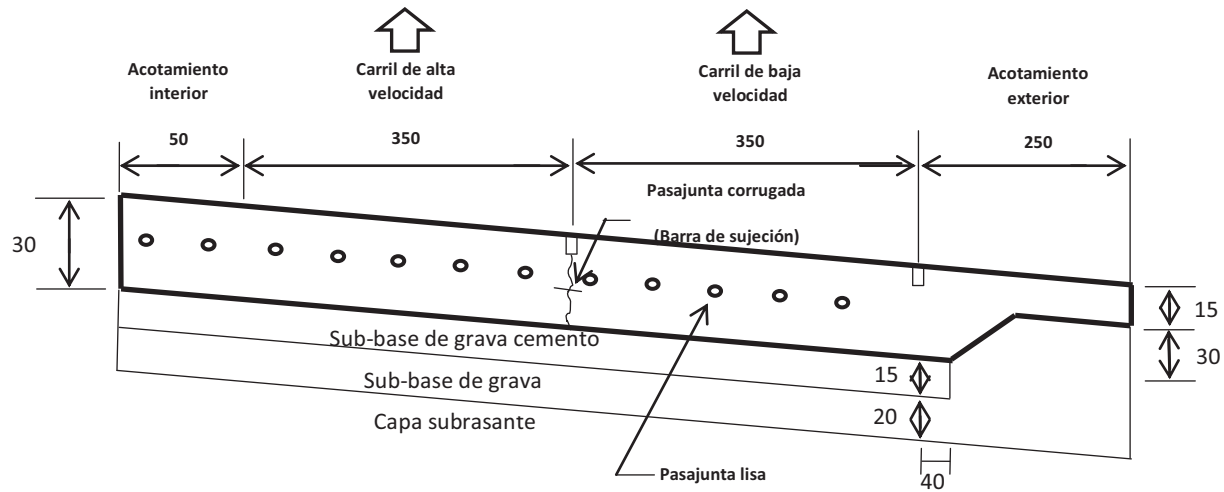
Sección transversal típica de un pavimento rígido para carreteras.
